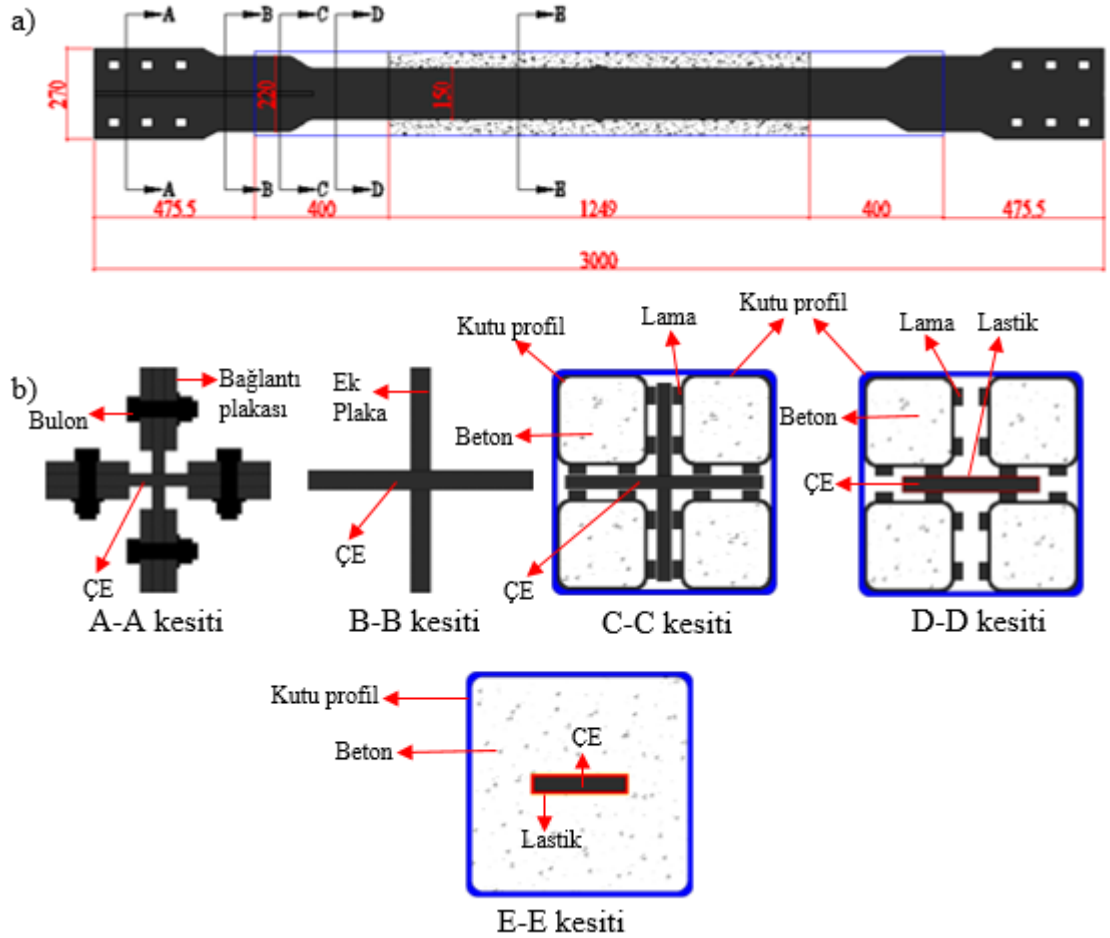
1.BEÇÇ elemanına ait detay çizimleri (FBA-2014-79 nolu proje)
